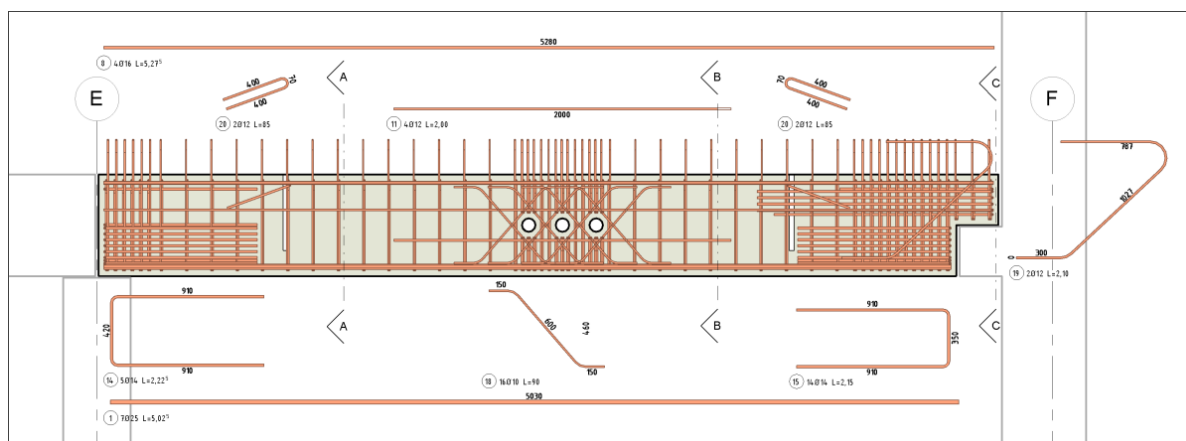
Erzeugter Bewehrungsplan eines Stahlbetonträgers mit Ausklinkung [34]
